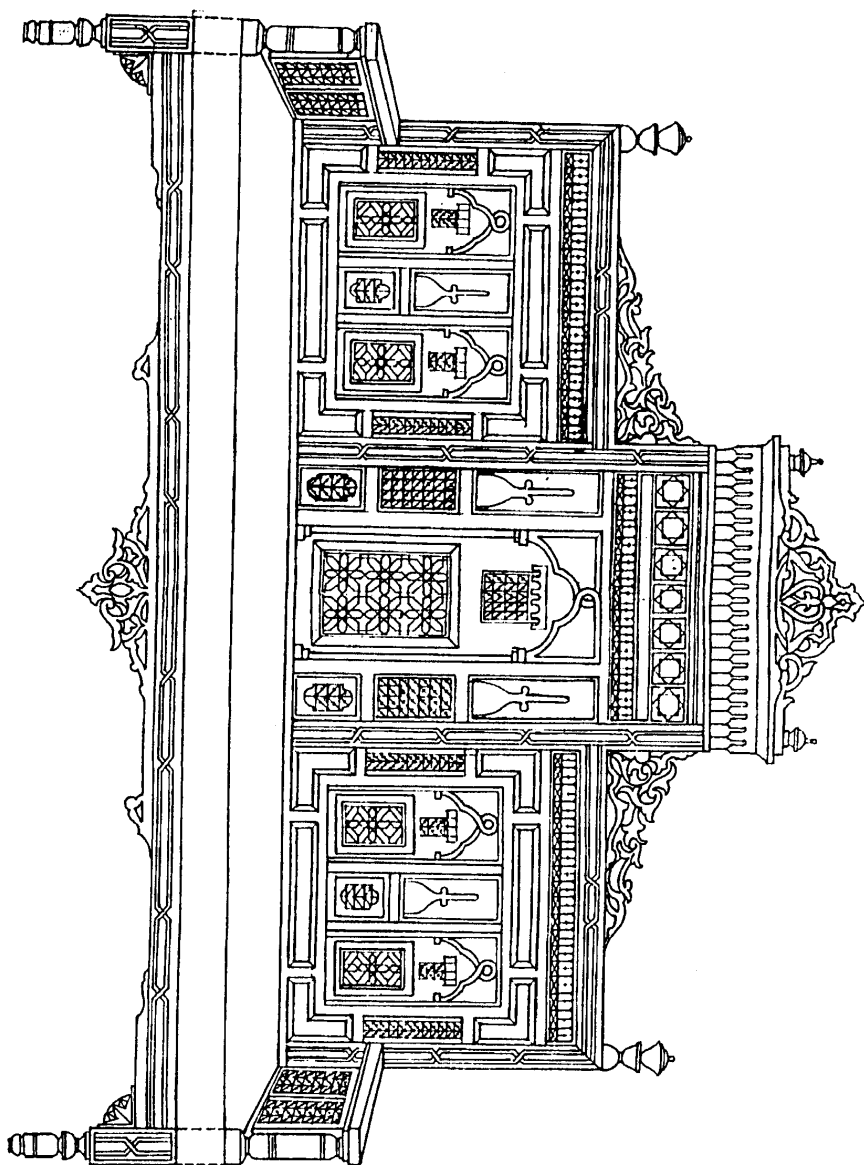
مسقط أفقي لسقف خشبي لمحل سياحي بالهرم (تصميم المؤلف)
